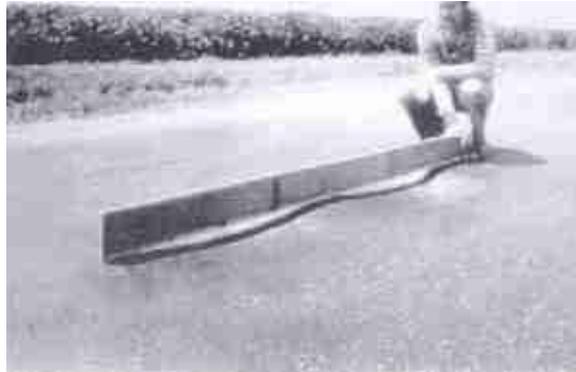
Falla Corrugación – Severidad Baja
